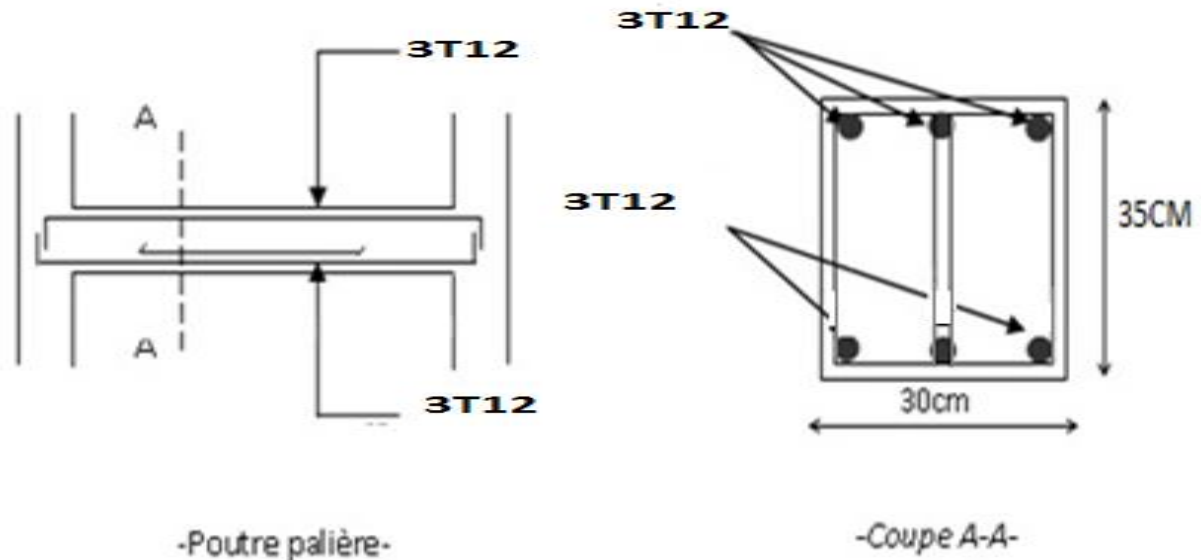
Schéma de ferrailage de la poutre palière
